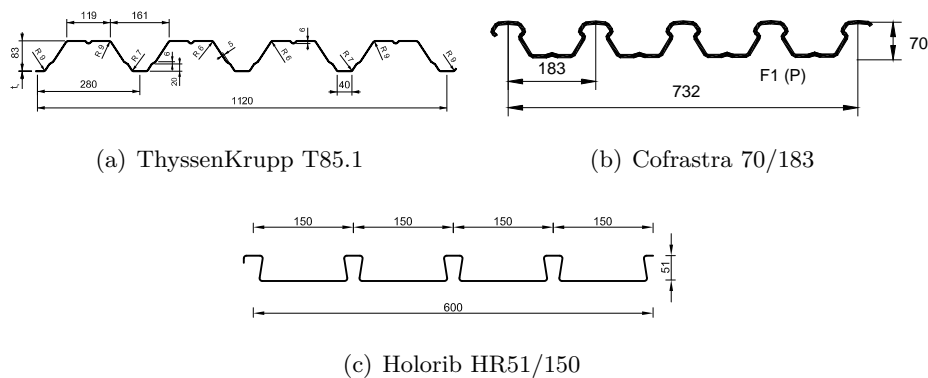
Verwendete Trapezprofilblechgeometrien
